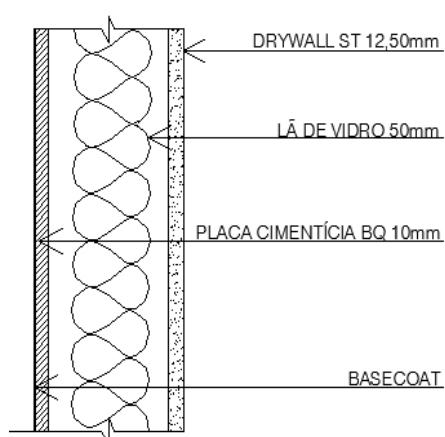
Configuração típica (seção transversal) das paredes externas do sistema construtivo Saint-Gobain.
